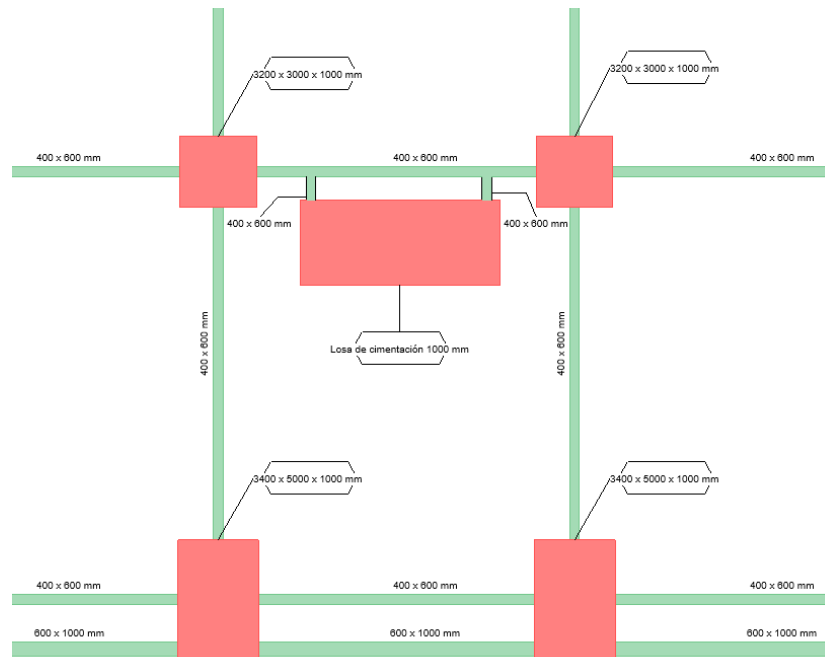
Vista de planta de la cimentación de uno de los núcleos de ascensores.
